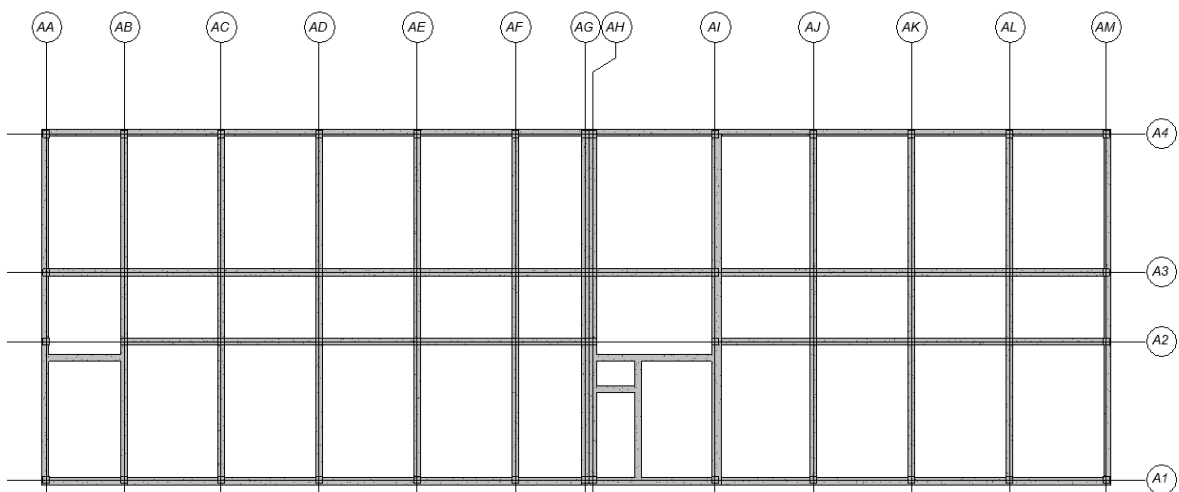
Vista en planta del forjado de la planta primera del Aulario
